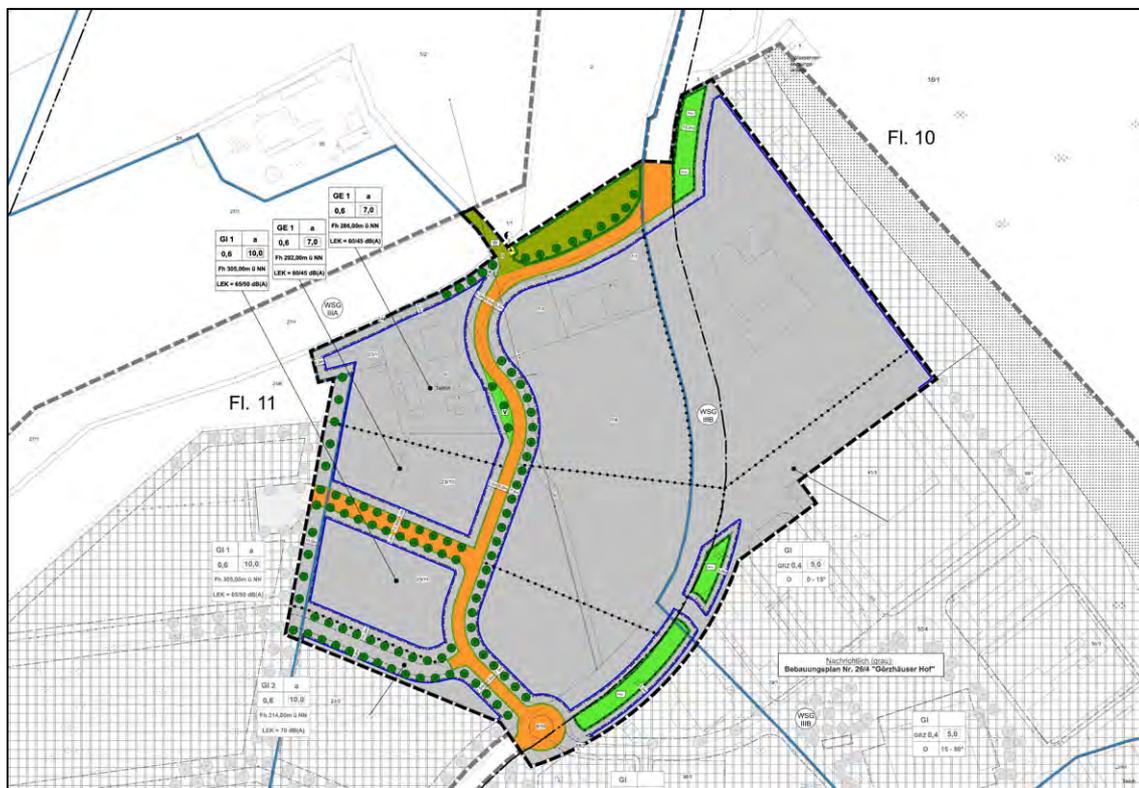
Bebauungsplan, Teilgeltungsbereich I – Planteil
